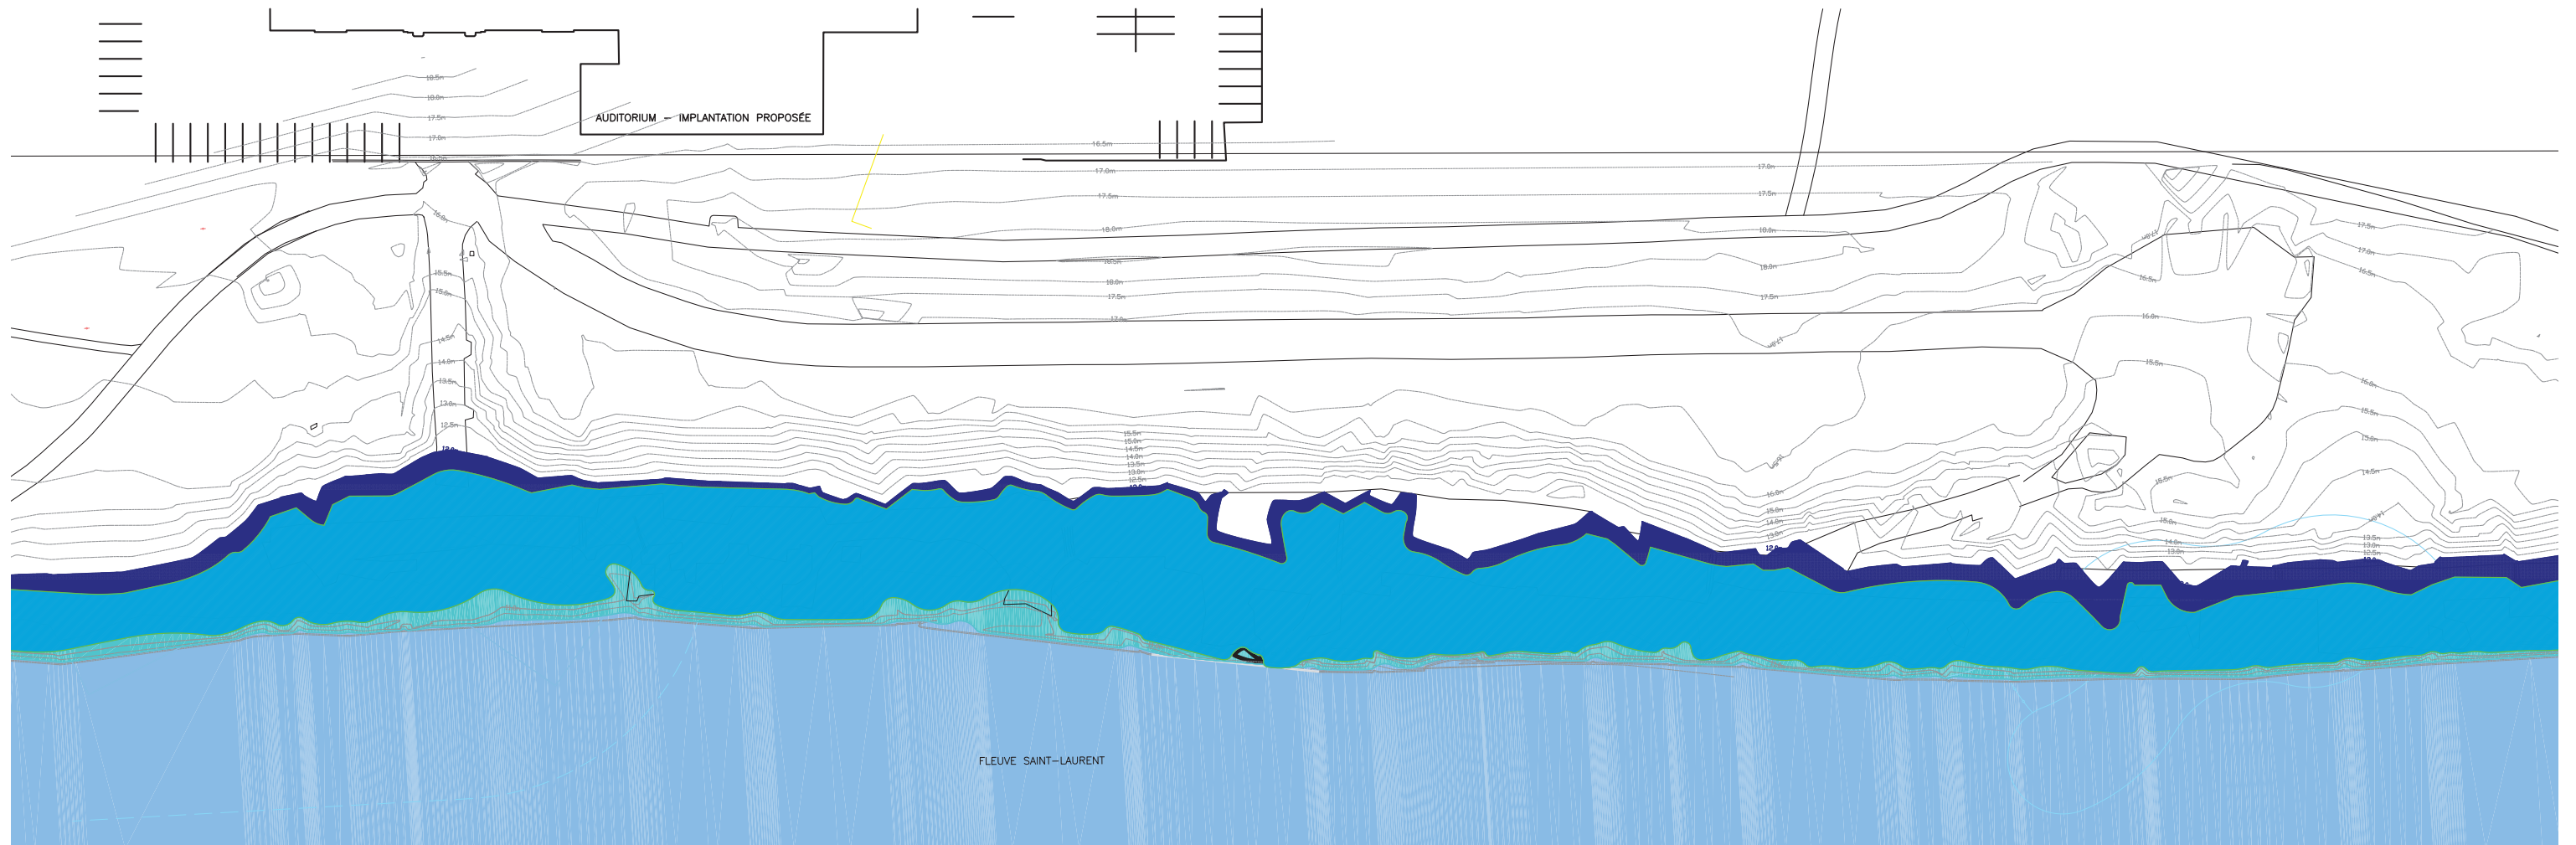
Plan des inondations - WAA & Lasalle | nhc
